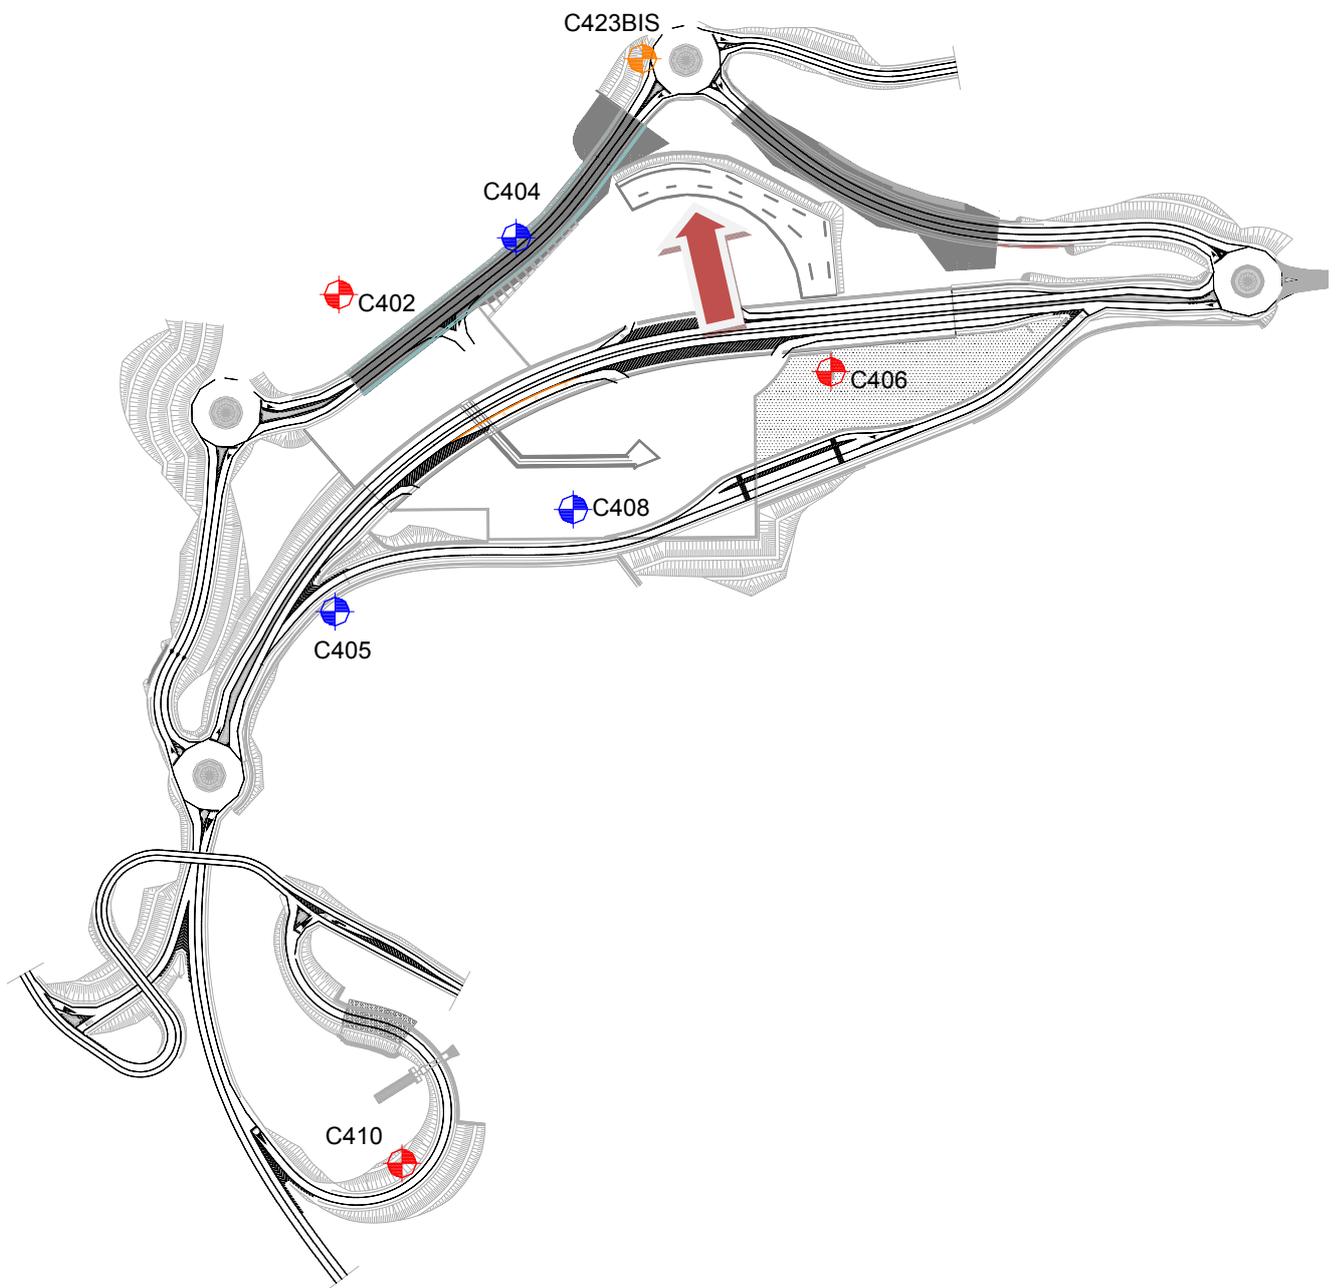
Stralcio planimetrico con ubicazione delle opere e dei sondaggi
